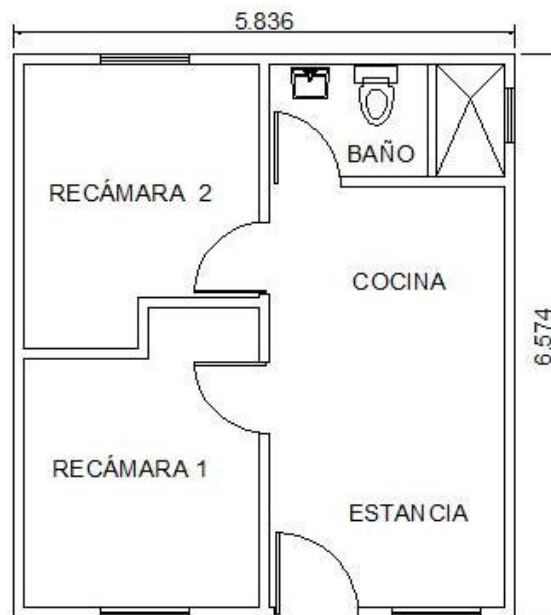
Planta Arquitectónica de la vivienda económica 38 m².
